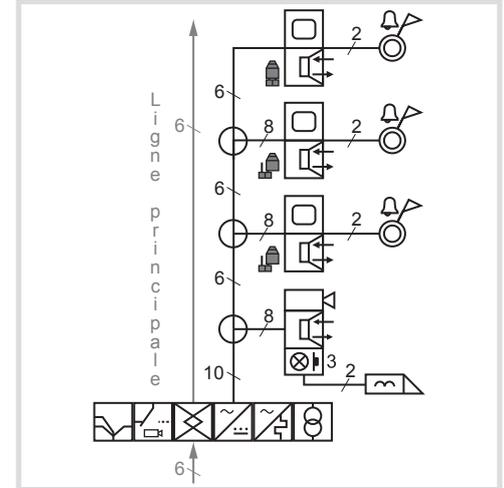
Vidéo 6D - Raccordement d'une station de porte d'étage
